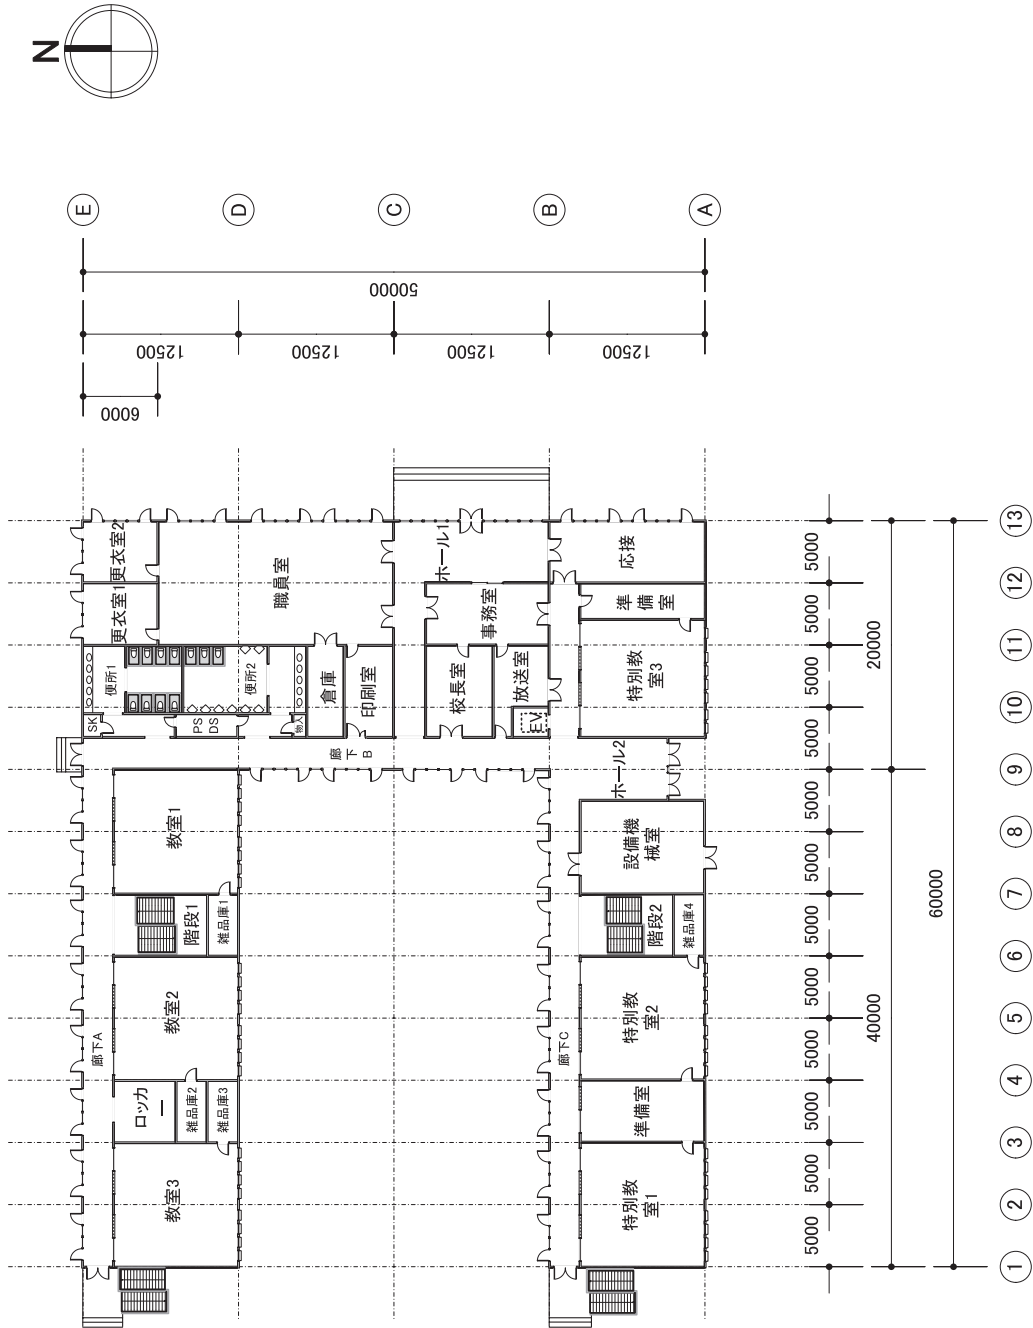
モデル建物 (学校等、5,000㎡) 1階平面図
